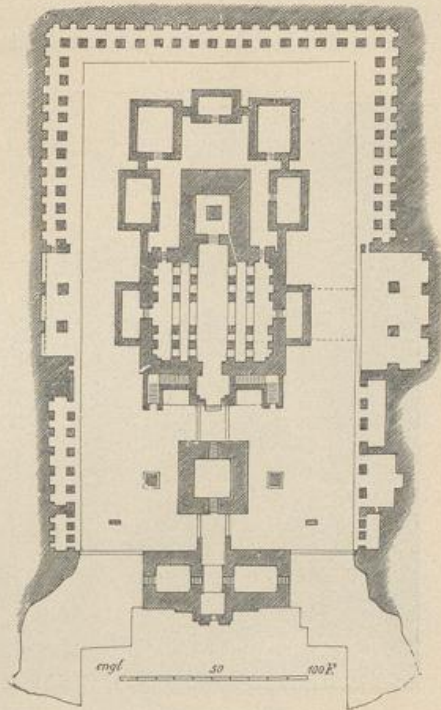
Grundriss der Kailasa-Grotte zu Ellora
